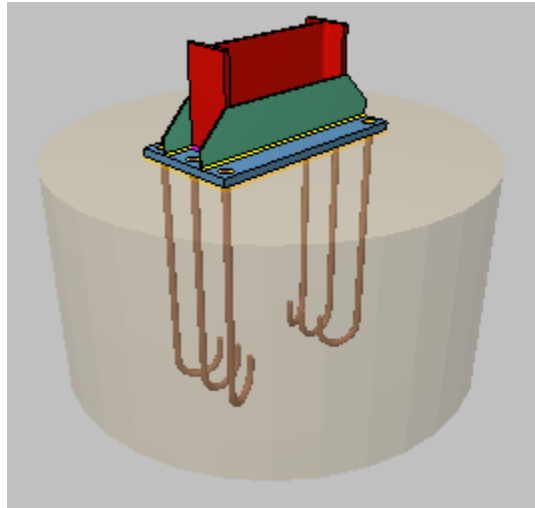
Placa de anclaje pilares fachada delantera en CYPE 3D.
